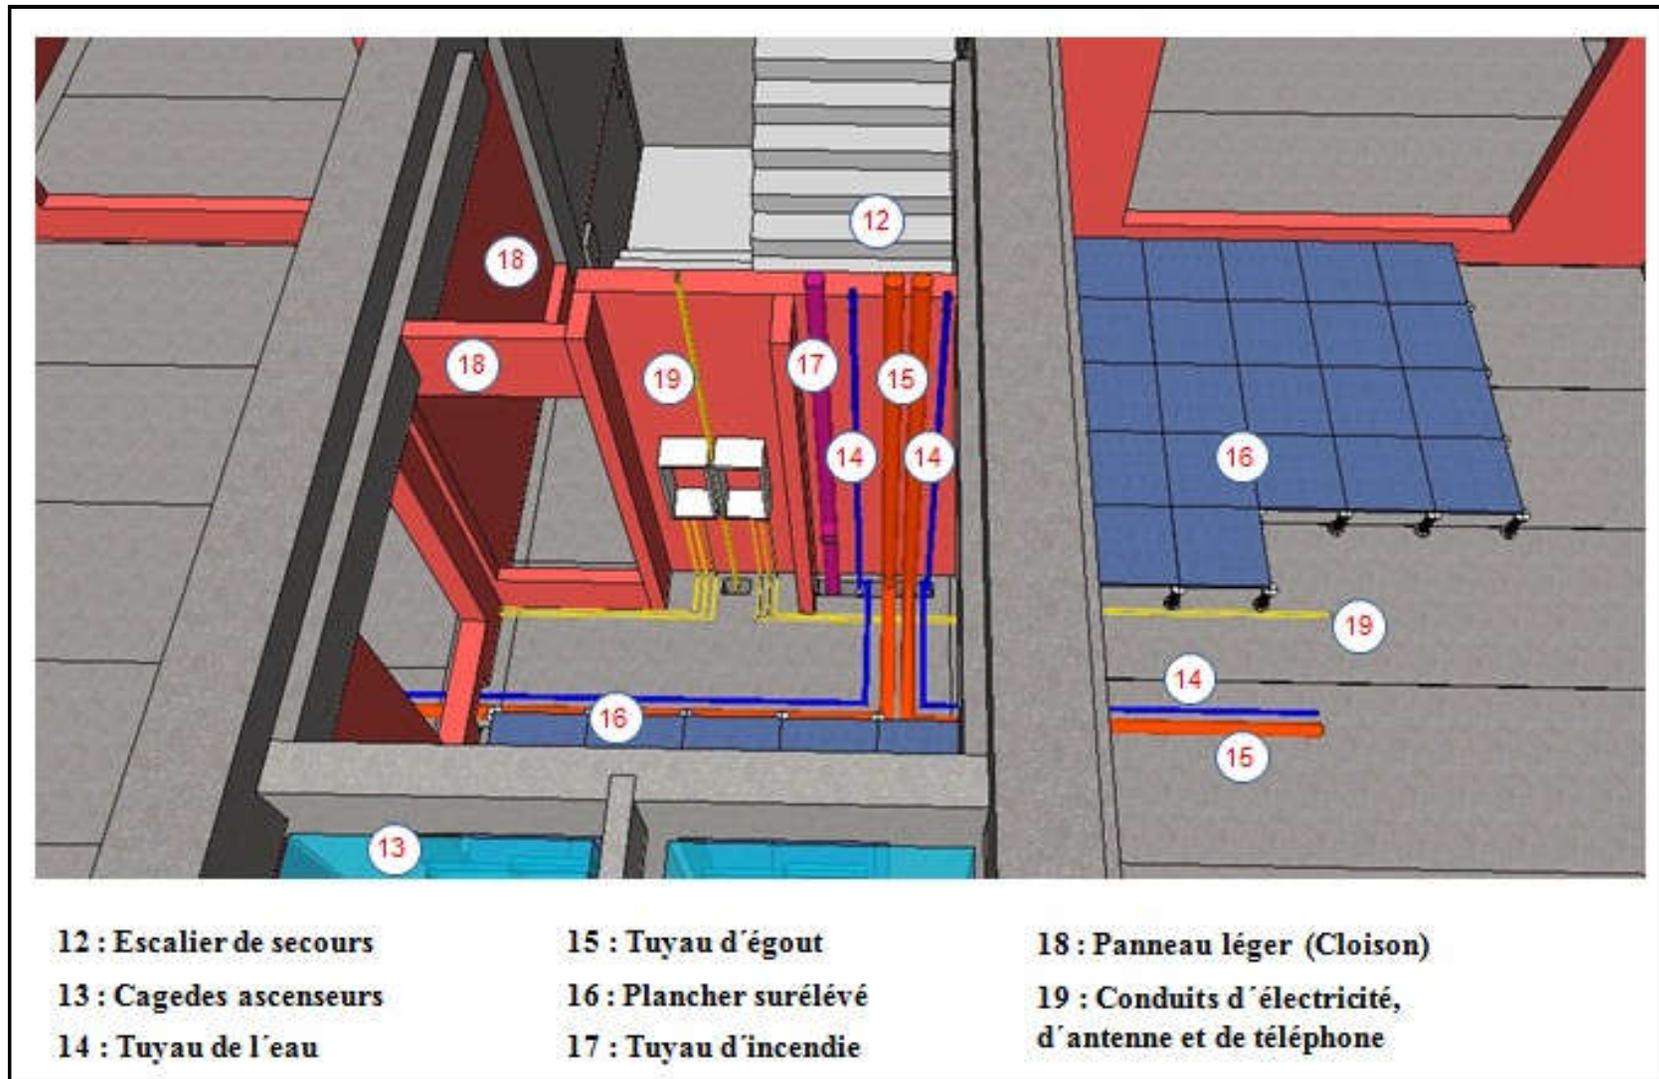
Perspective de la zone servante du bâtiment en poutre et colonne.
